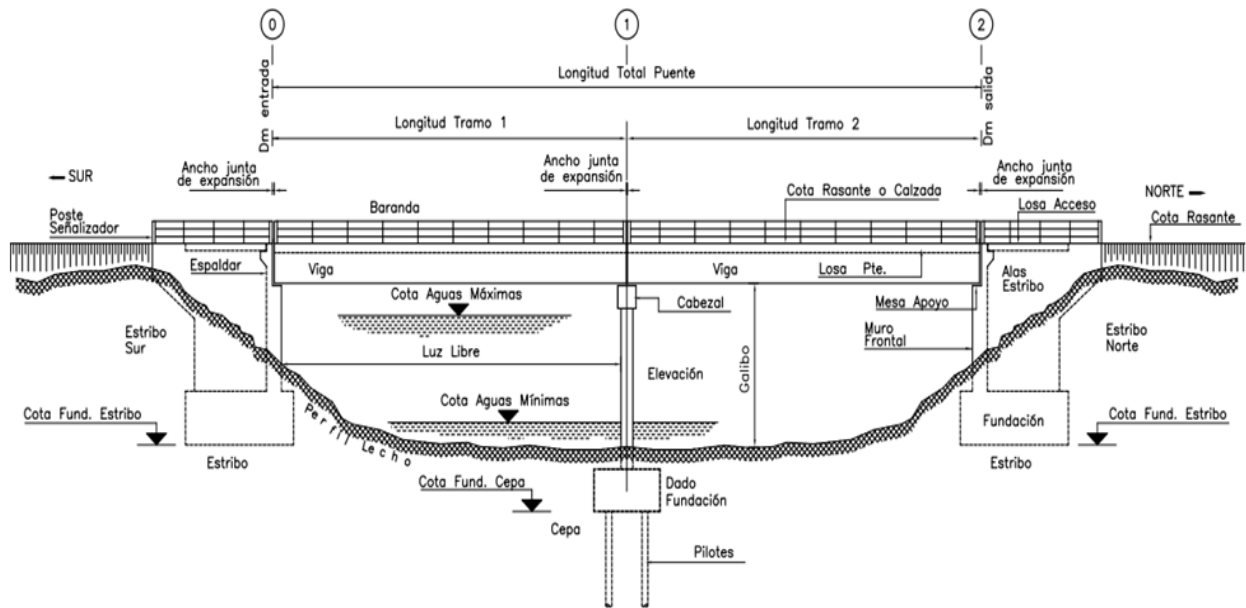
Esquema característico Puente con Vigas Isostáticas (Manual de Carreteras, 2021).
